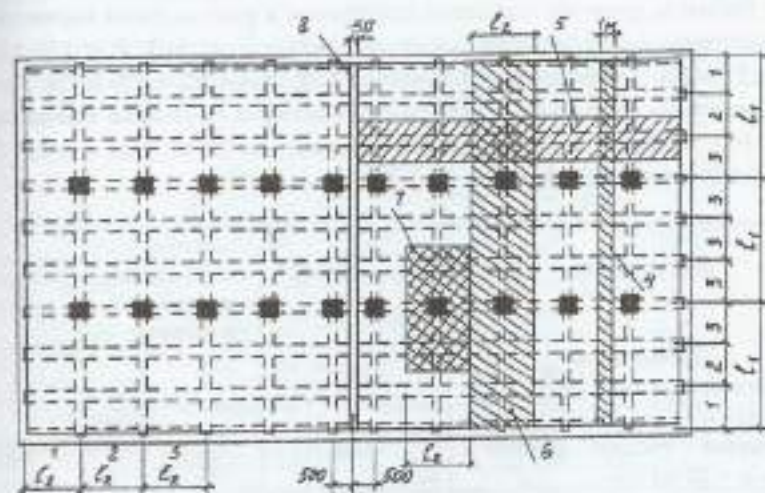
Конструктивная схема монолитного ребристого перекрытия с базовыми плитами:
